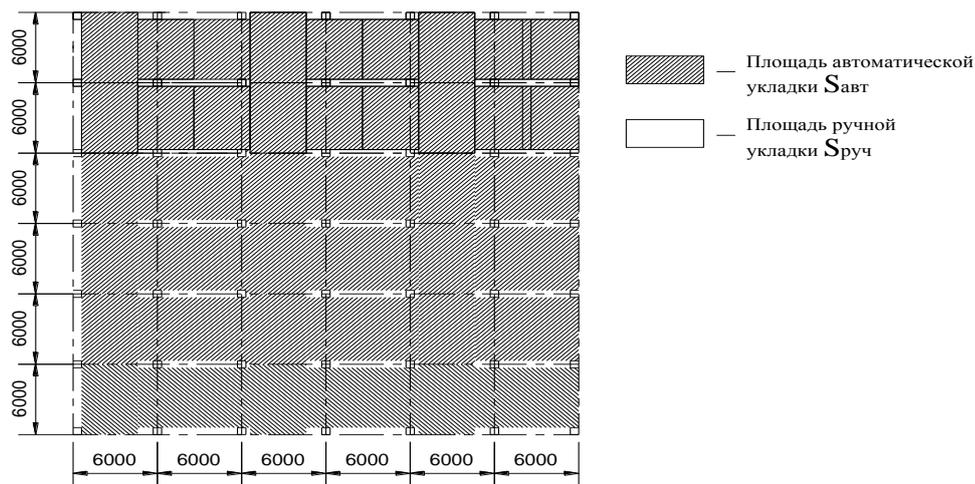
Схема укладки бетонной смеси автобетоноукладчиком при сетке колонн 6х6.
